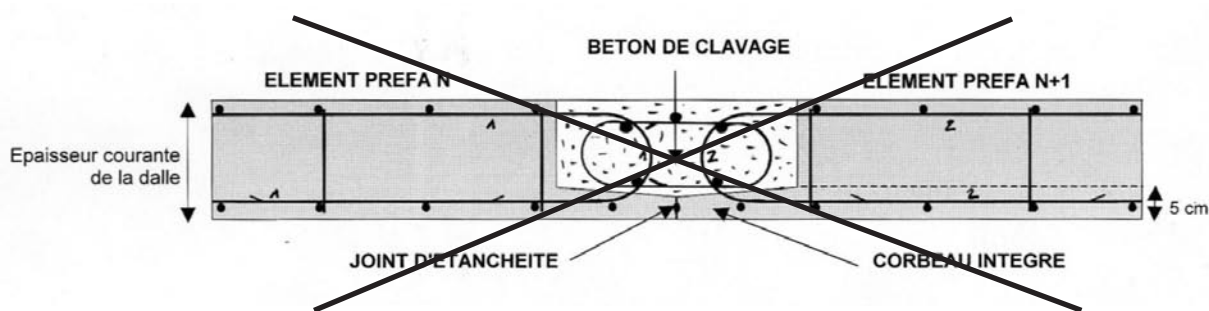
Disposition déconseillée dans le cas de dalles préfabriquées de pleine largeur
